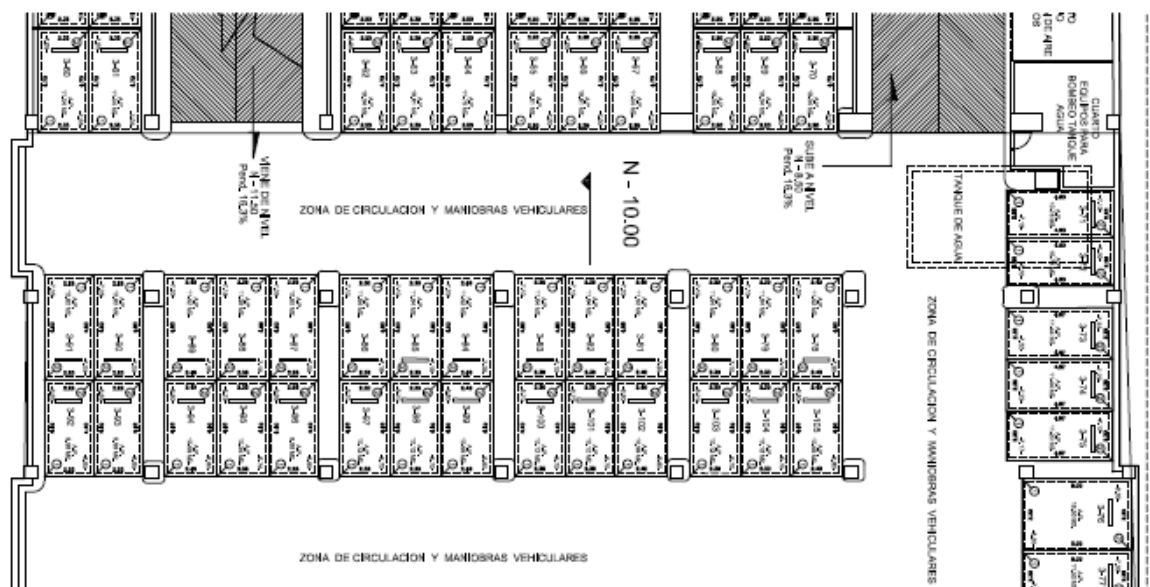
Planta Arquitectónica Nivel de sotano N-10.00
